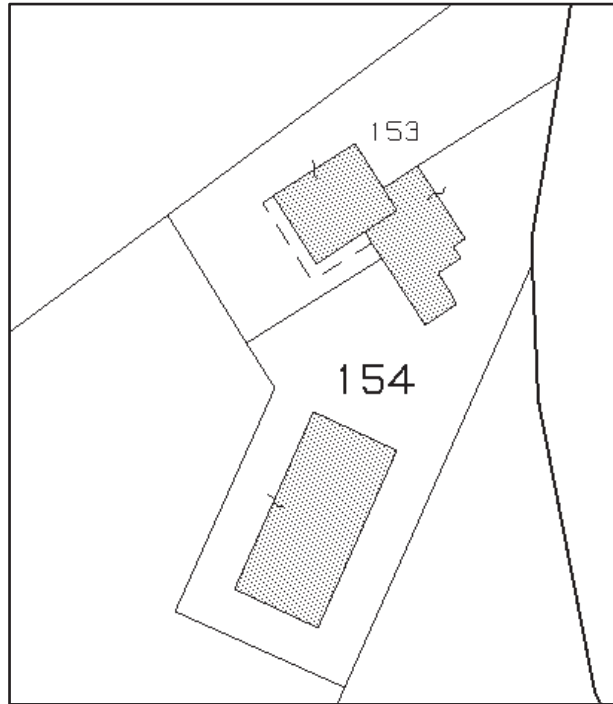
Estratto dell'elaborato planimetrico attuale (piano terra)
